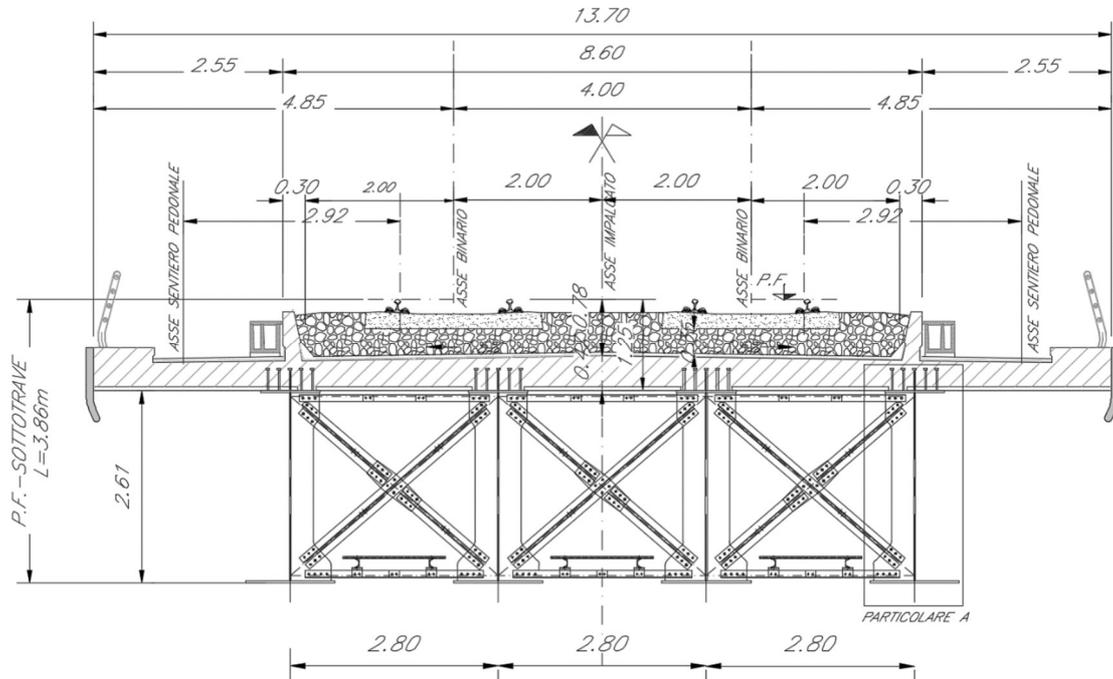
Sezione tipo - Ponte a struttura mista acciaio calcestruzzo a doppio binario
